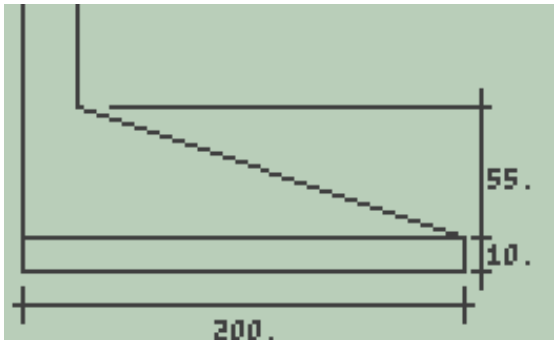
Sapata em divisa - Detalhamento da sapata - corte.
